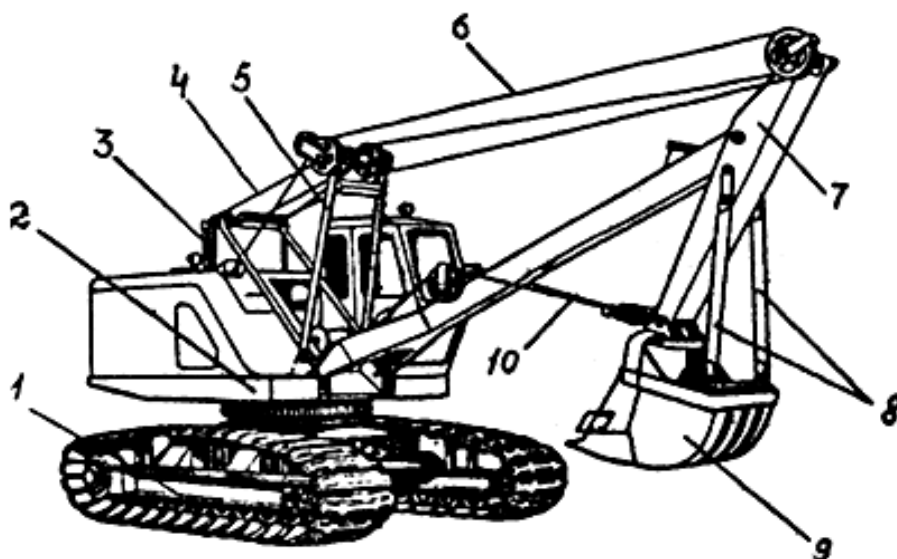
Гусеничный экскаватор 3-й размерной группы с механическим приводом и рабочим оборудованием «обратная лопата» 1 —ходовое устройство; 2 —поворотная платформа; 3 —стойки; 4, 6 —канаты; 5 —стойки блоков; 7 —рукоять; 8 —тяги реактивные; 9 —ковш обратной лопаты; 10 —канат тяговый.
